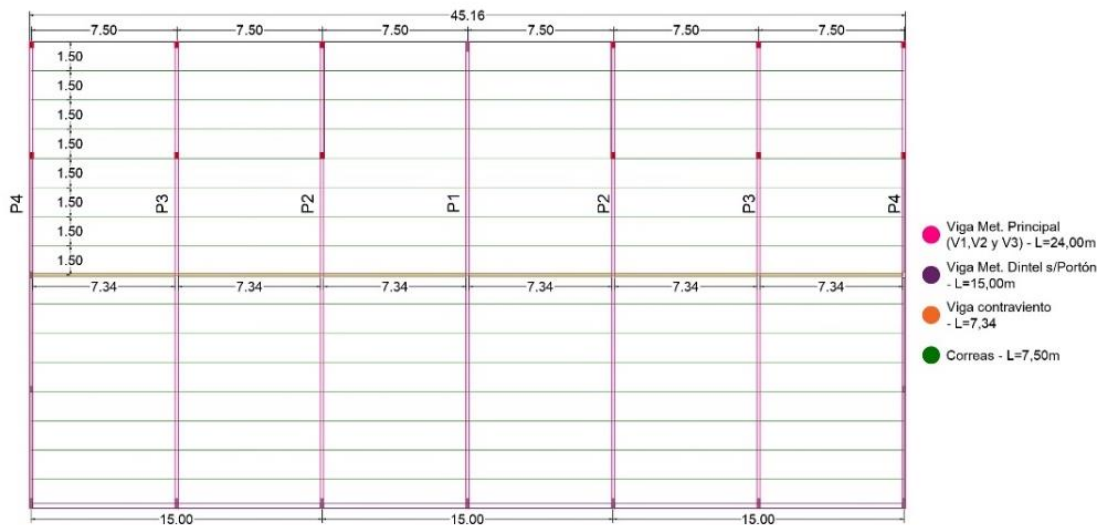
Planta general de techos. Fuente: Elaboración propia.
